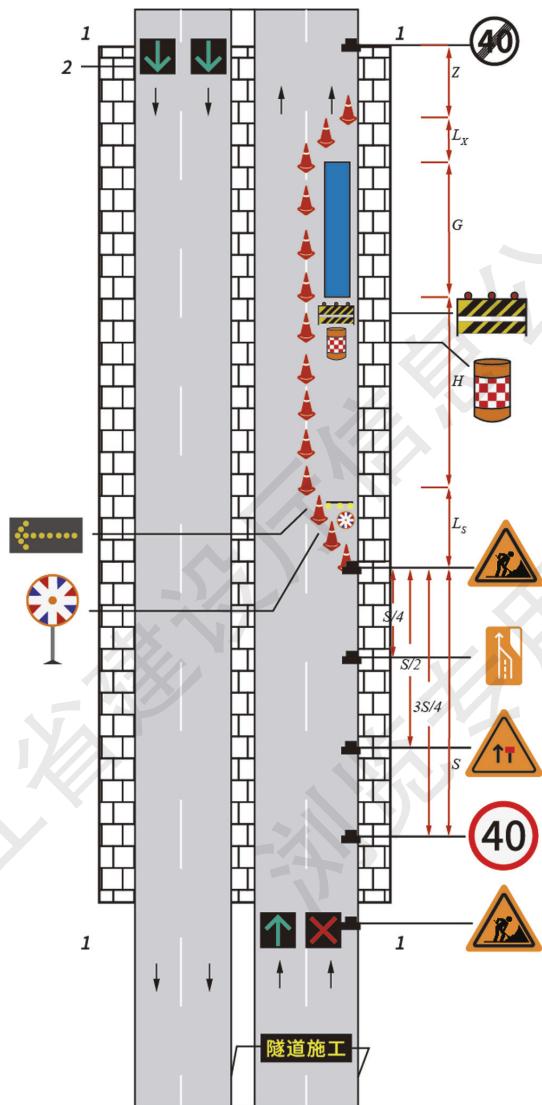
隧道工作区距洞口不小于 1000m 时养护作业控制区布置示意
